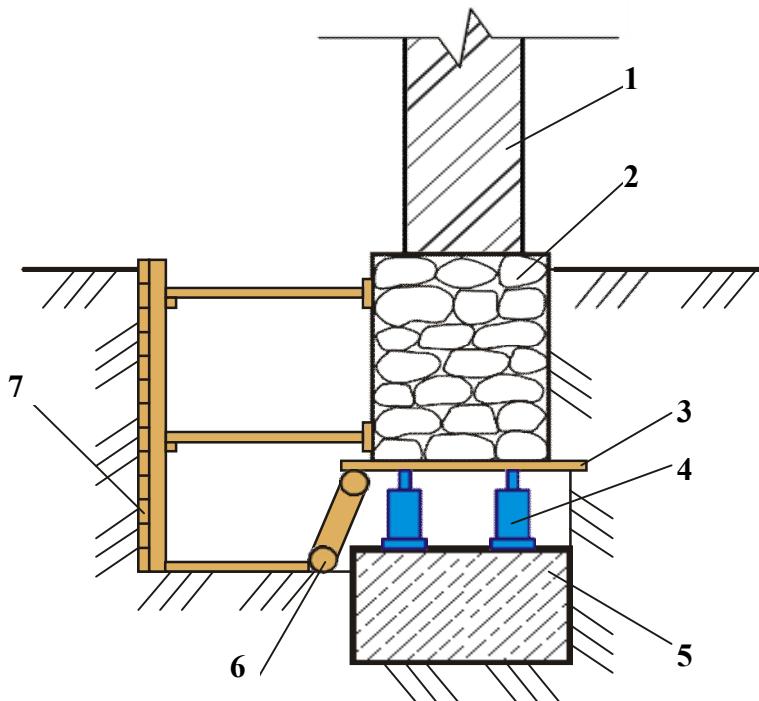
Поглиблення фундаменту окремими блоками: 1 – стіна; 2 – фундамент; 3 – закидки; 4 – домкрат; 5 – бетонний блок; 6 – дерев'яна рама; 7 – інвентарні щити
